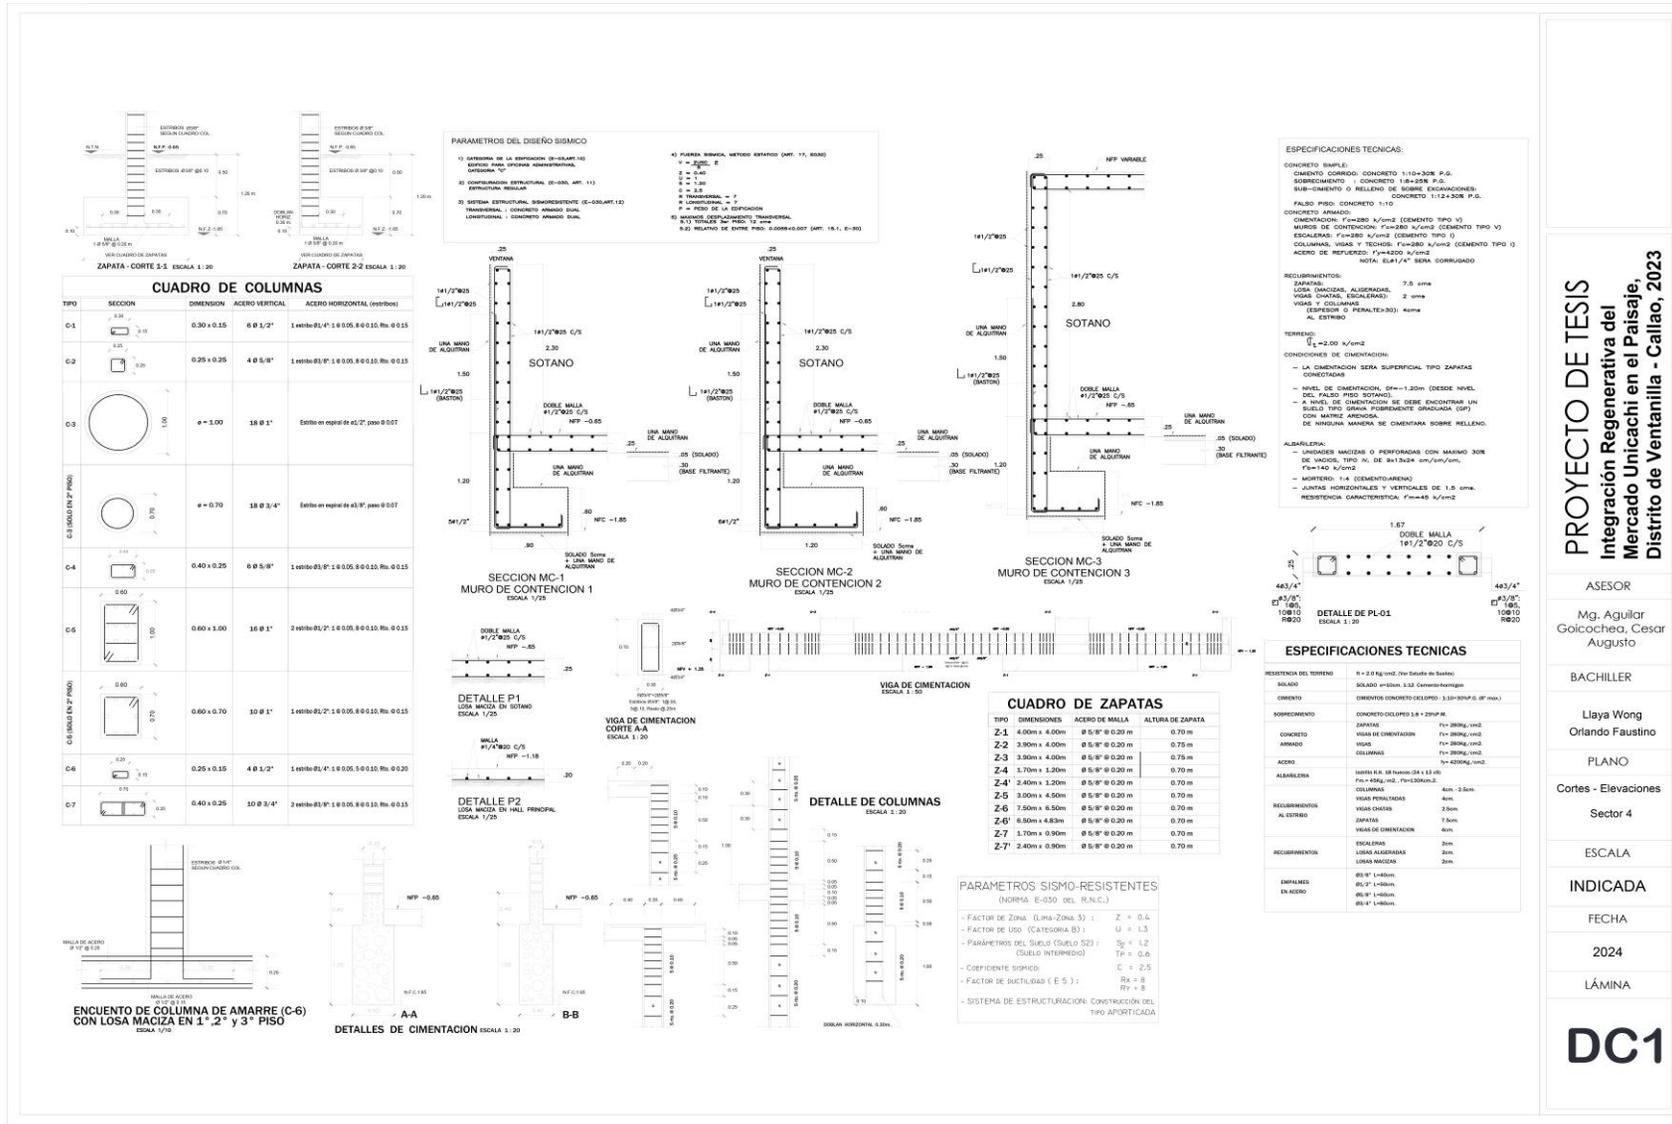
Plano de Detalles Constructivos de Pilares y Columnas de Concreto, elaboración propia.
